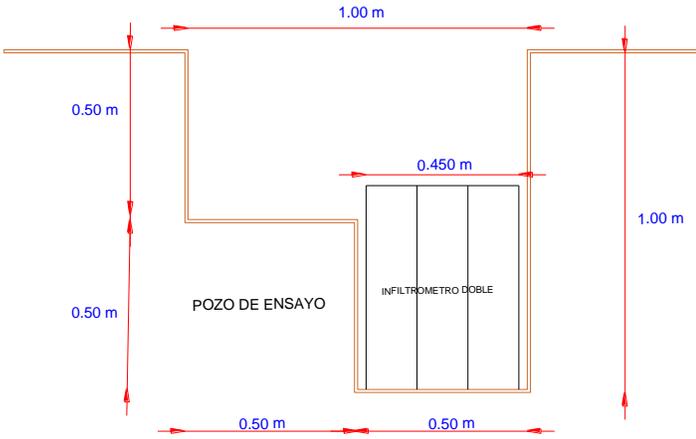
Corte de la Gaveta, Pozo de Ensayo e Infiltrómetro.
